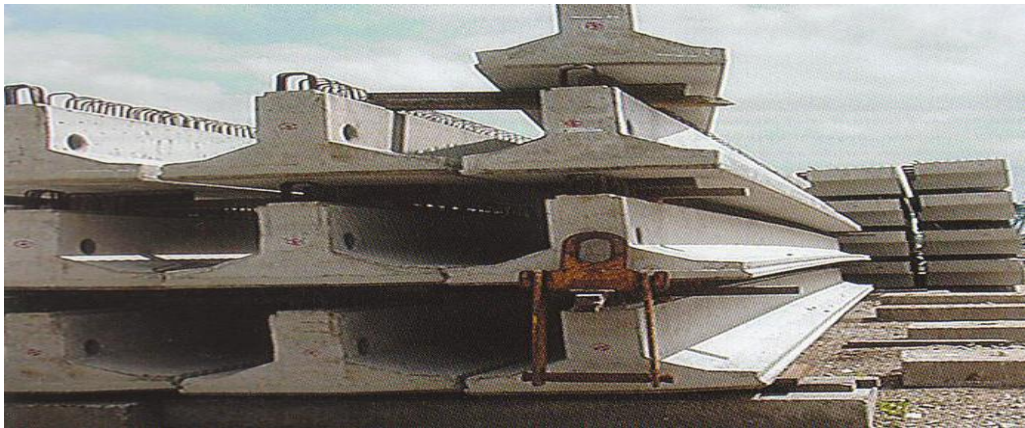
Armazenamento de estruturas pré-fabricadas [14]
